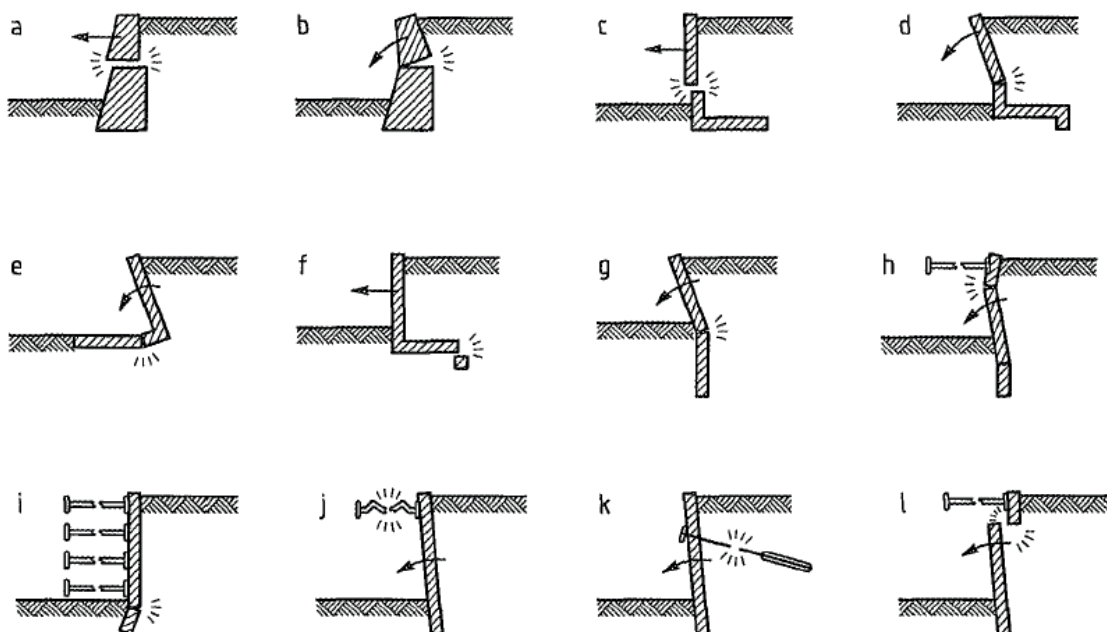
Exemplos de modos limites para a rotura estrutural de estruturas de suporte
